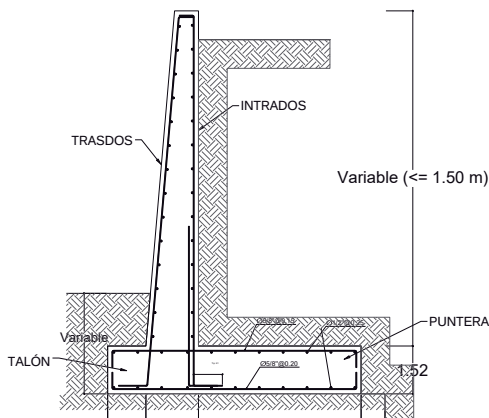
Detalle típico de muro de contención. Elaboración propia.
